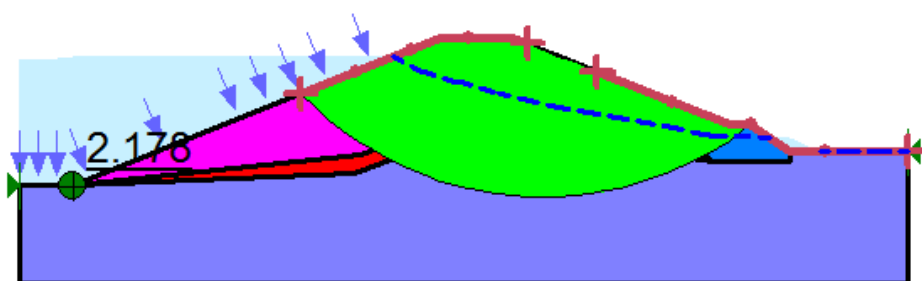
非常运行工况 I 校核洪水位下滑弧面位置
